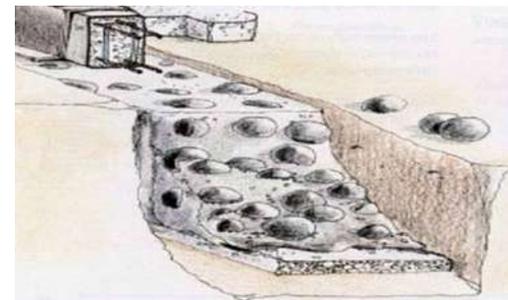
Cimiento corrido de concreto ciclópeo.NMG.
